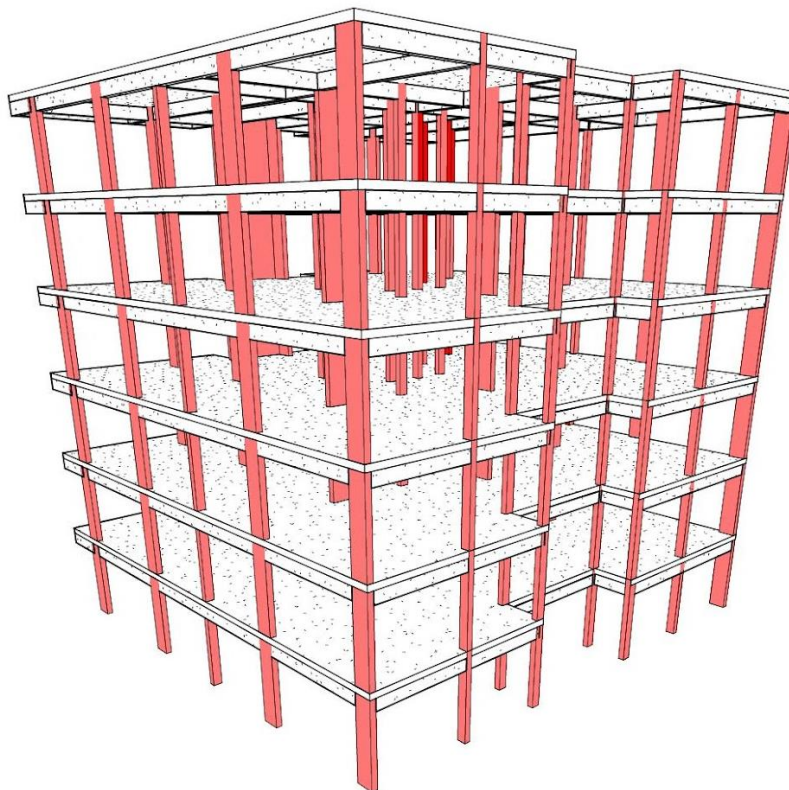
Projeto estrutural, laje maciça concreto armado - Fonte: Os próprios autores
